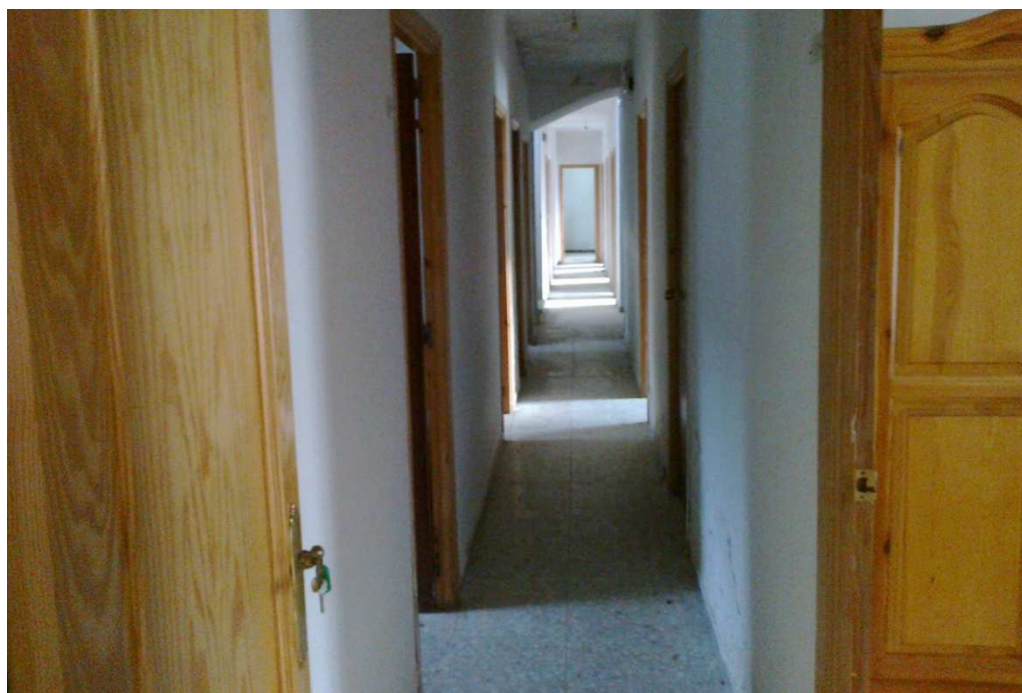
Pasillo distribuidor de la zona de baños de la planta baja.
